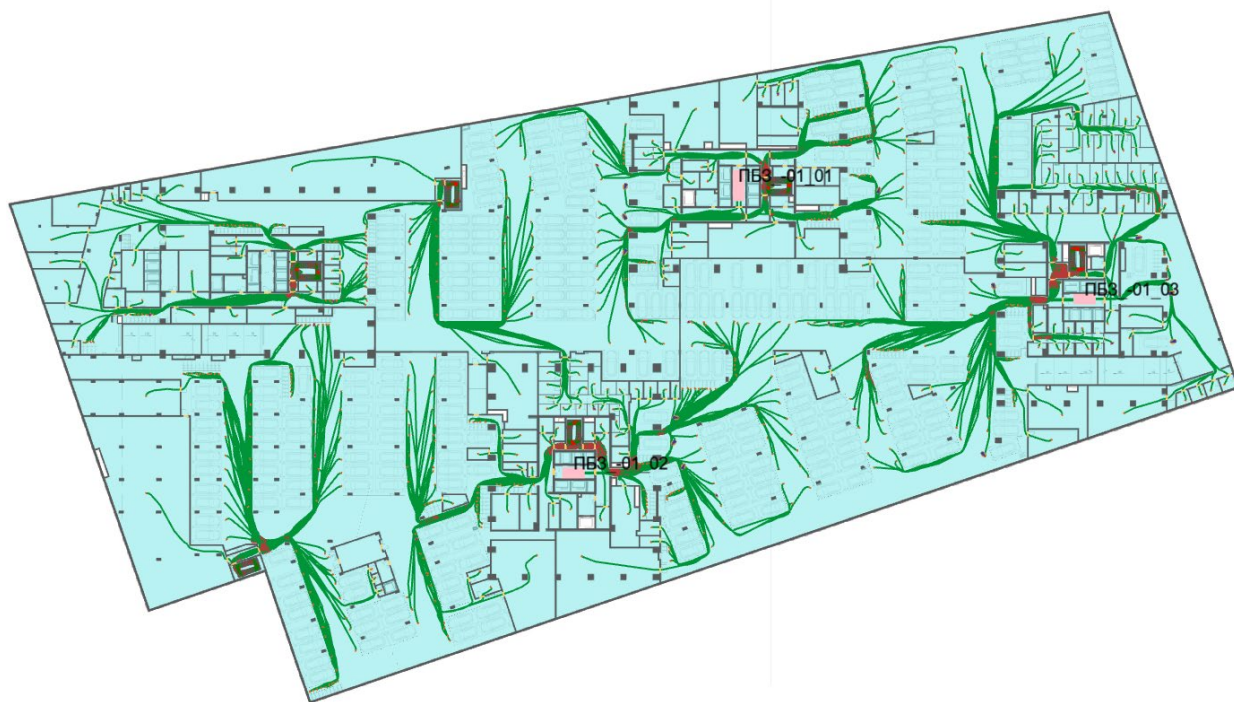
План минус 1-го этажа и нанесенная на него расчетная (принципиальная) схема эвакуации
